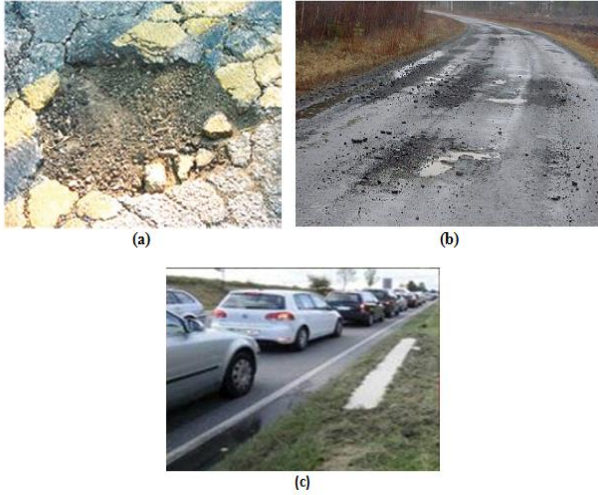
Otoyol kenarındaki kirleticiler ve kaynakları [44].
